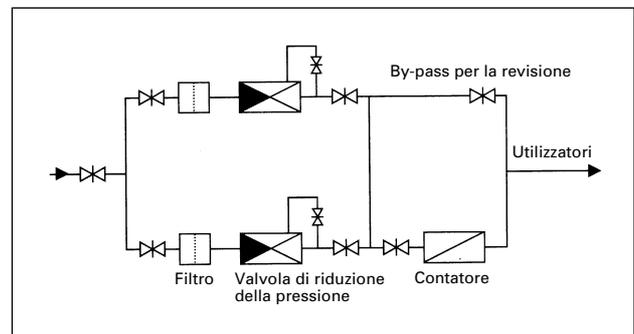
stazione di riduzione della pressione del gas e stazione di misurazione (stazione DRM)
